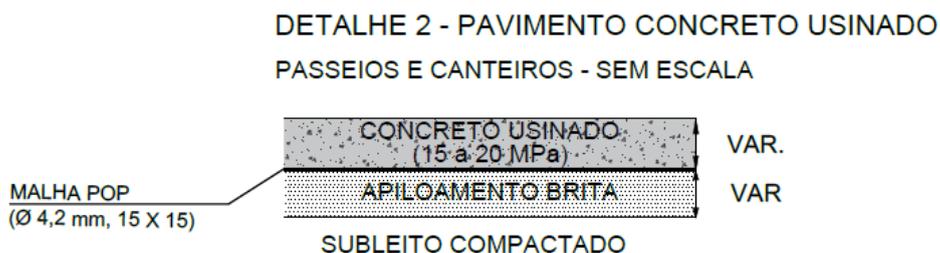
Pavimento Concreto Usinado Calçada de 5 cm
